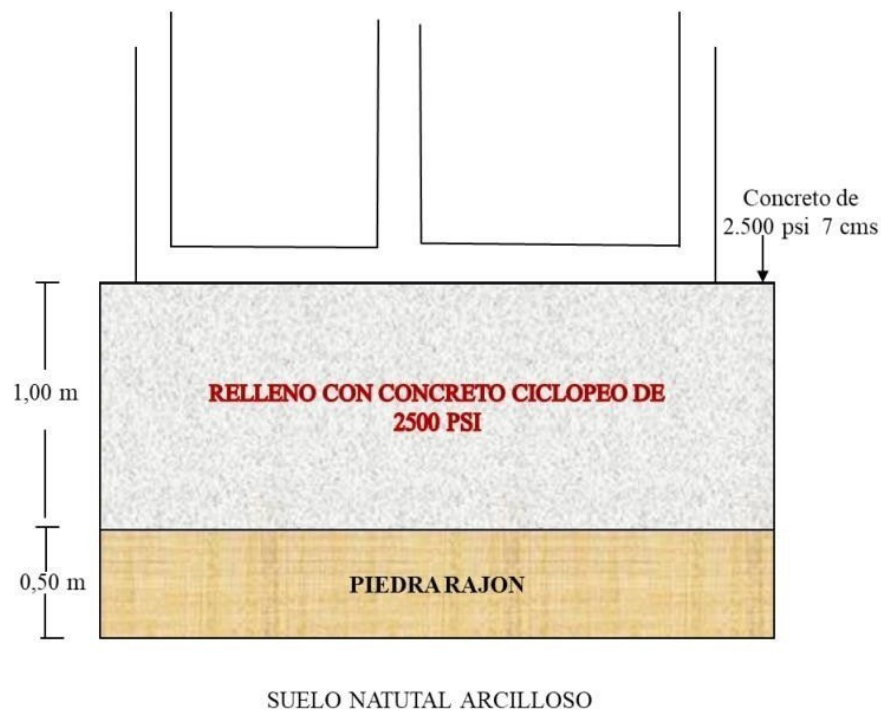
Detalle de cimentación para fondo de Box Culvert.
